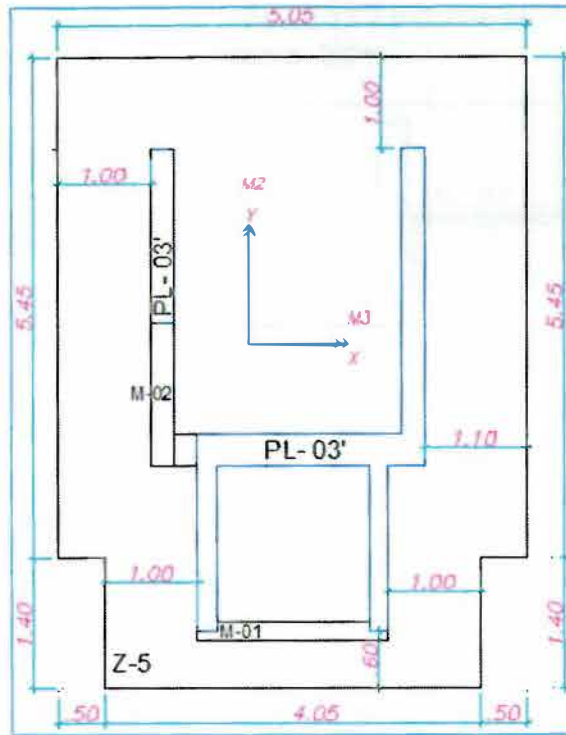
a Planta de Zapata y muros del asesor y escalera
